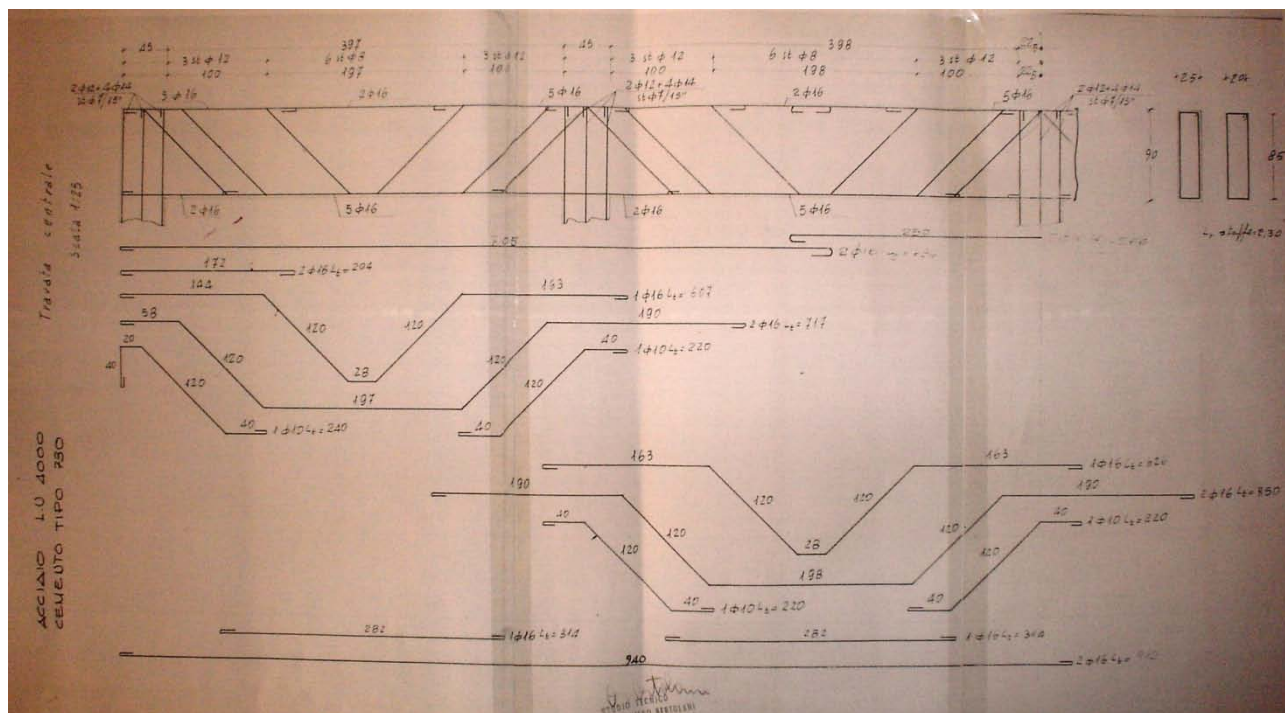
Estratto tavola strutturale trave porzione ampliamento – solaio di calpestio piano terra
